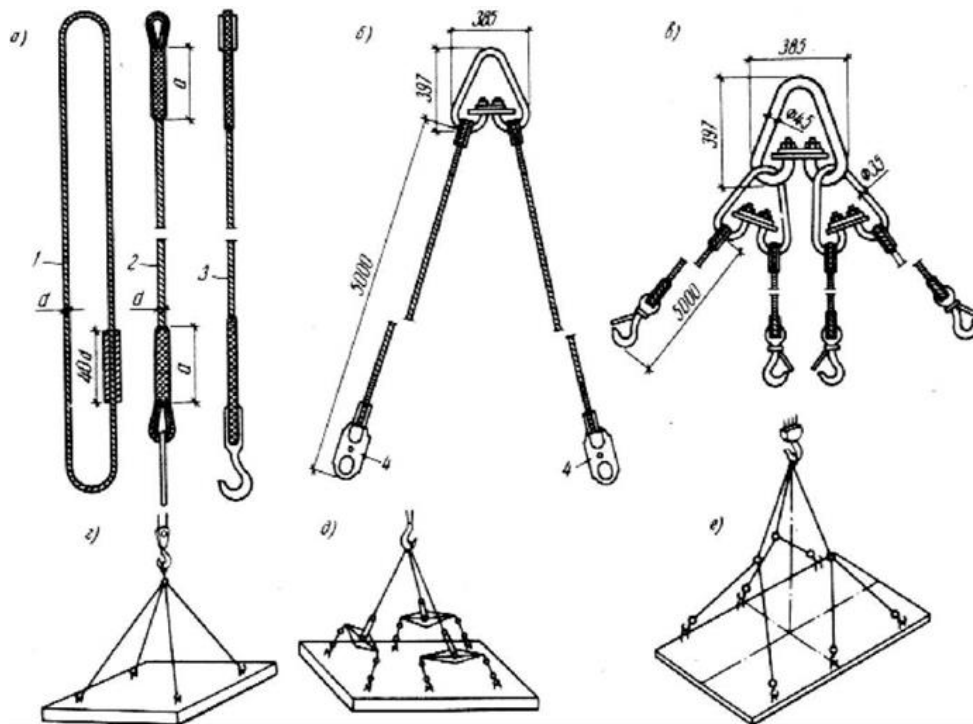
Стропи й стропування конструкцій: а - гнучкі стропи; б - канатний двухветвевой; в - канатний чотиригілковий; г – строповка чотиригілковий стропом; д - те ж, трехтраверсным; е - те ж, трехблочная; 1 - універсальний строп; 2, 3 -облегченний з гаком і петлею; 4 - карабіни
